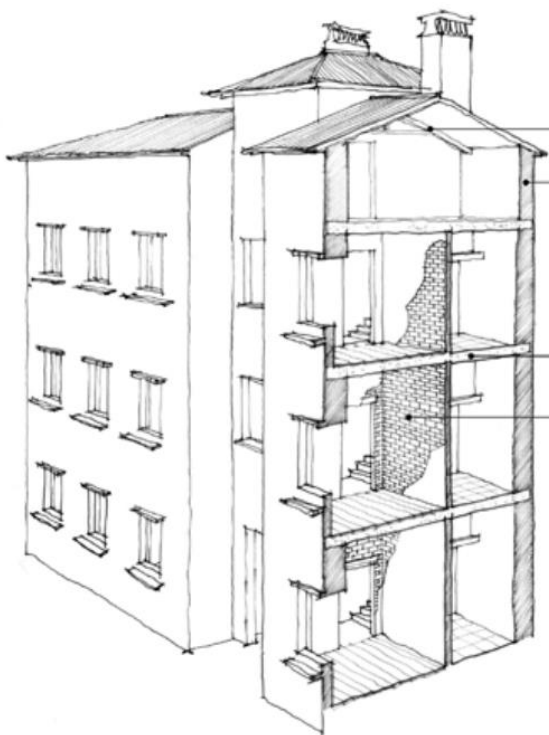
Esquema de um edifício com paredes de fachada em alvenaria com placa, (Fonte: Secção Regional Sul da Ordem dos Arquitectos, 2016))
